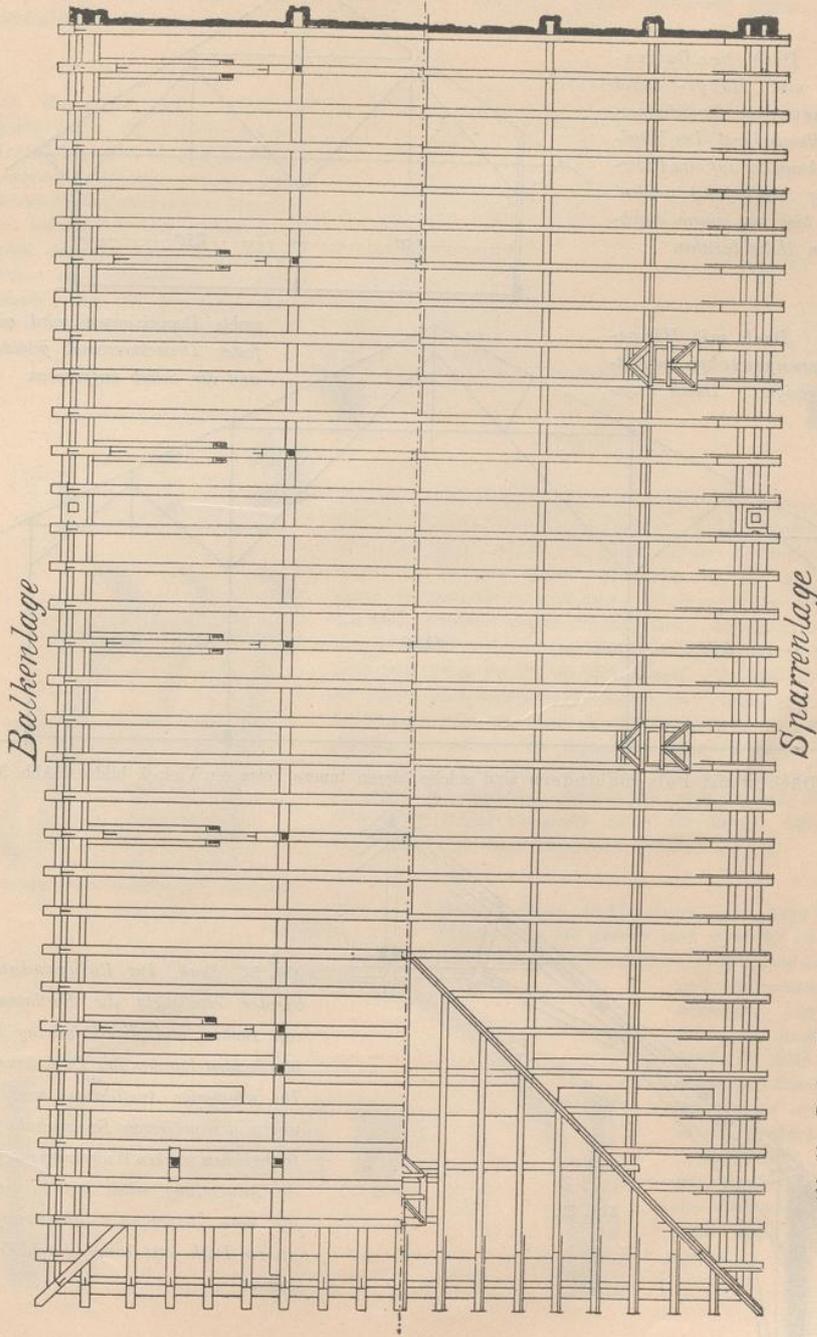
Dach. Hänge- und Sprengwerksdach mit Balkenlage. (Kirche in Schlüchtern.) Balken- und Sparrenlage.
